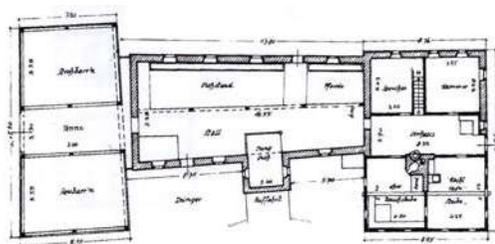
| Doppel T-Hof Grundriss
